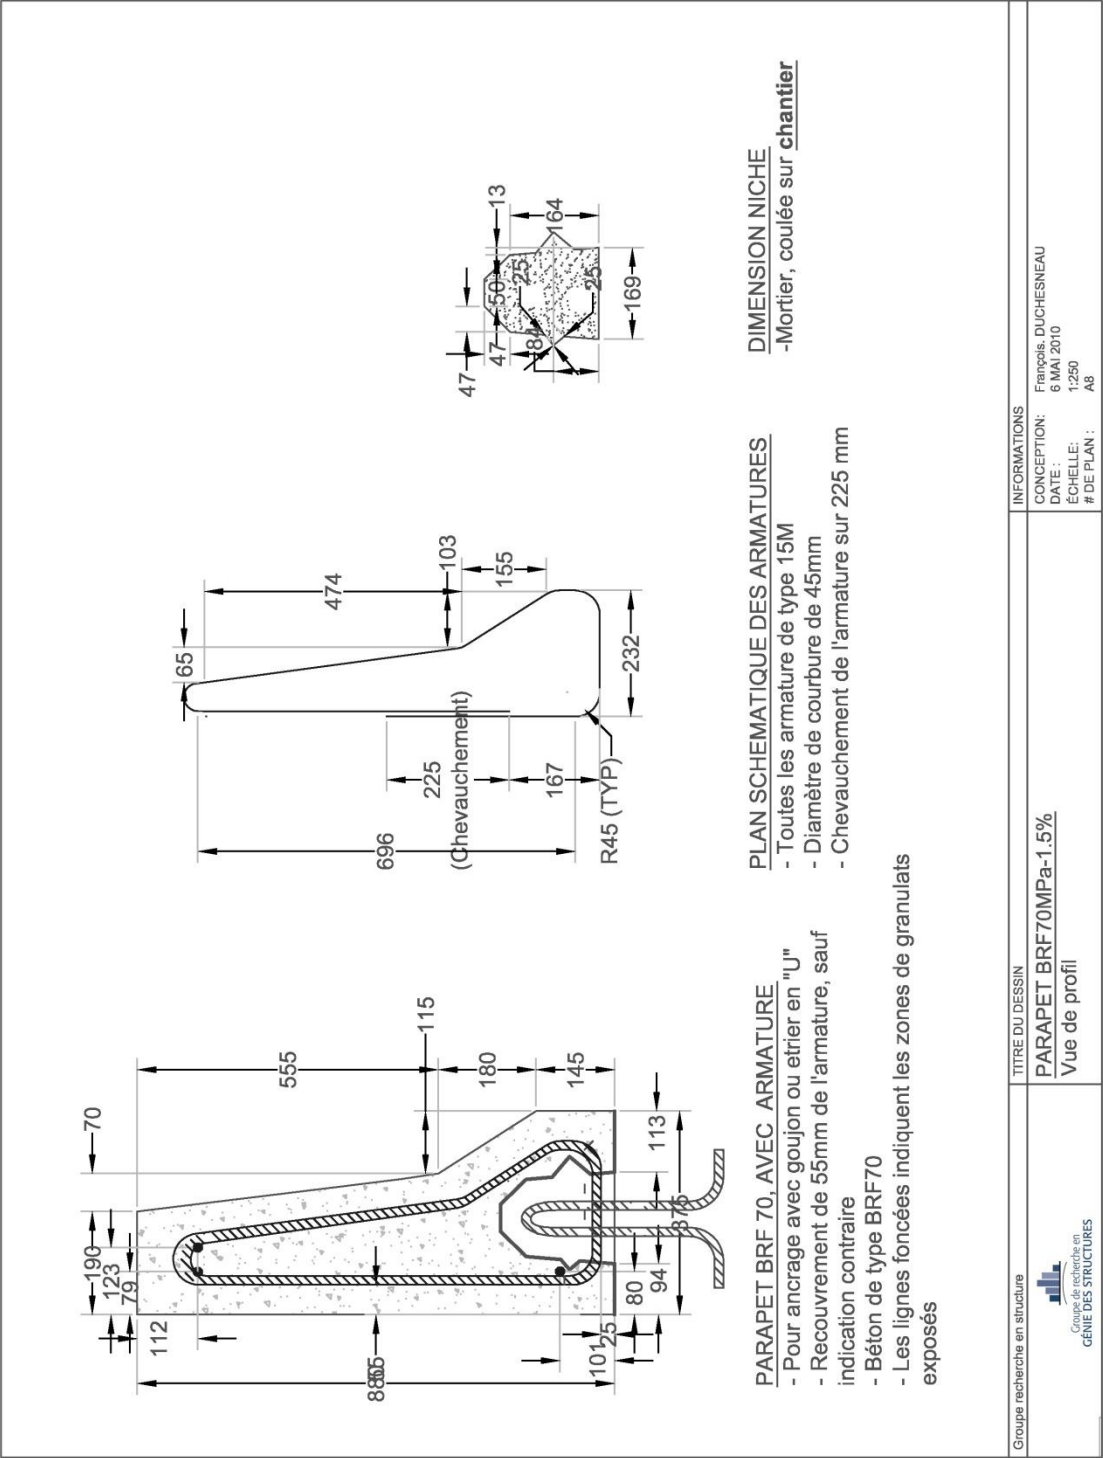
Plan de profil du parapet BRF70MPa-1.5%
